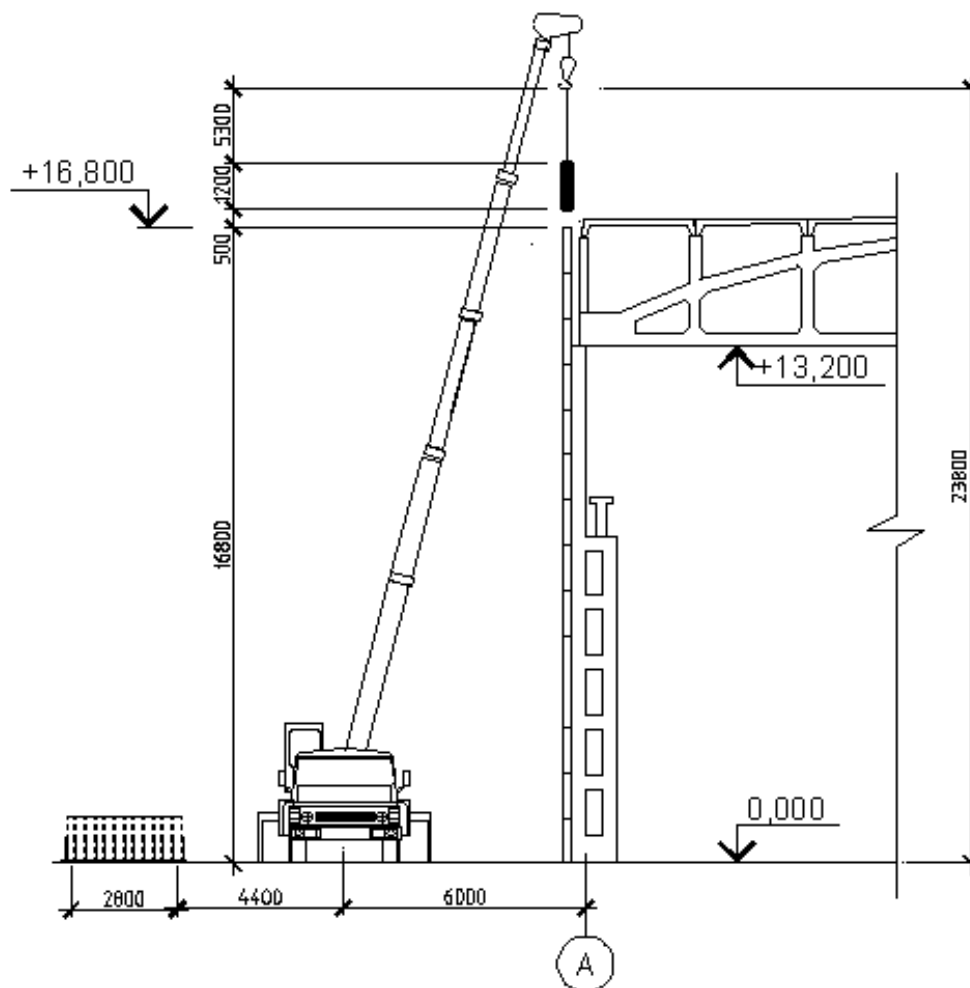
Разрез схемы монтажа наружных стеновых панелей высотой 1,2 м
